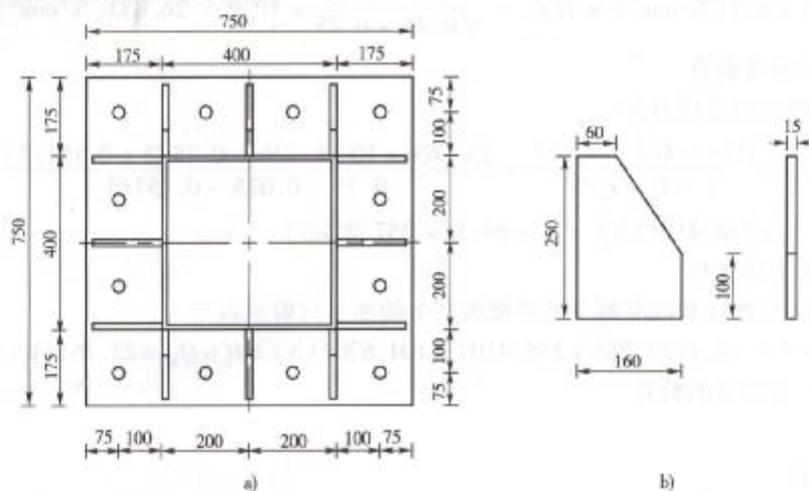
柱脚计算简图(尺寸单位:mm)
